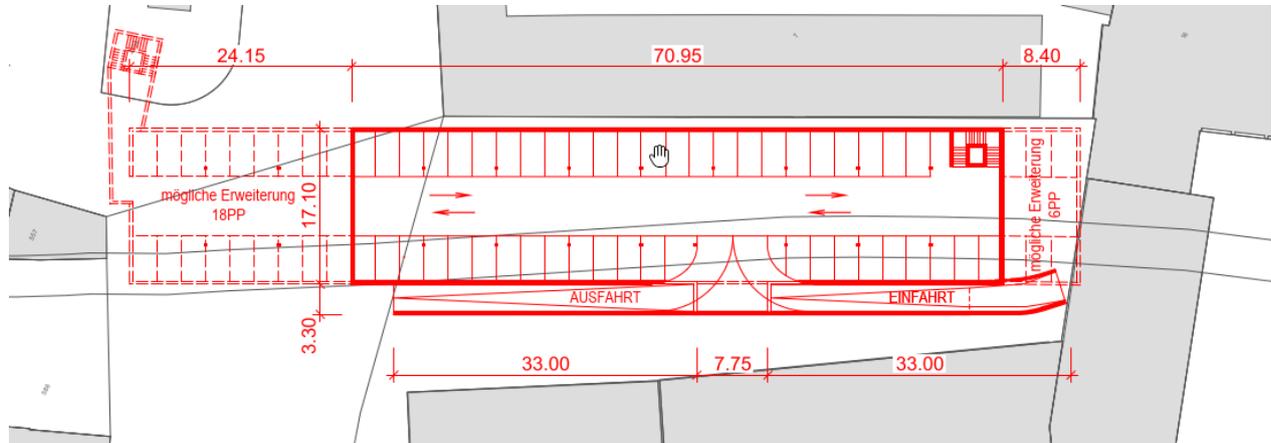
Ausschnitt Situation Variante Obergrund 1.1 Grundriss Parkgeschoss
